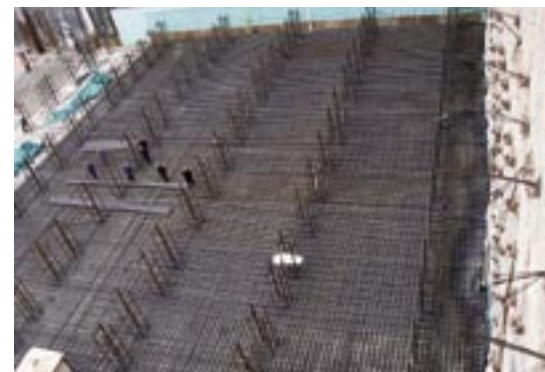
Расстановка опорных столиков для верхних арматурных сеток
